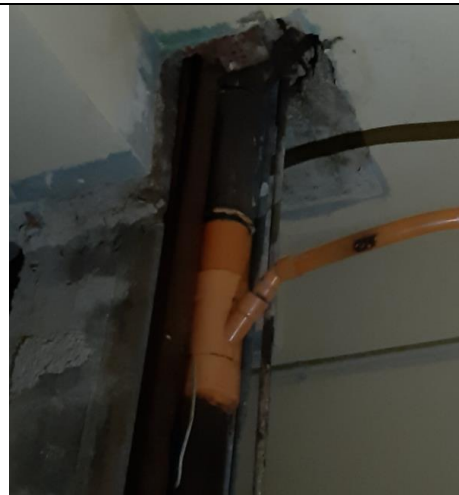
con intervento soluzione D - A e C, particolare G + rimozione tubo in ferro
